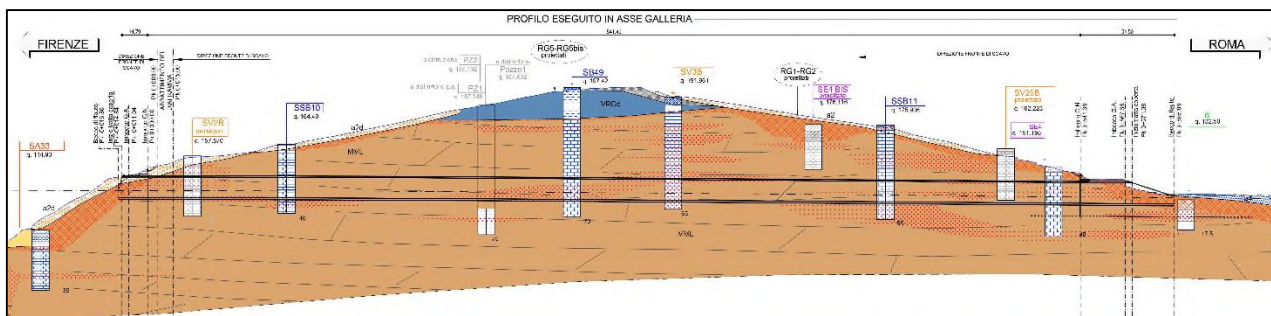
Stralcio da TUN01949 Profilo geomeccanico progettuale di previsione
